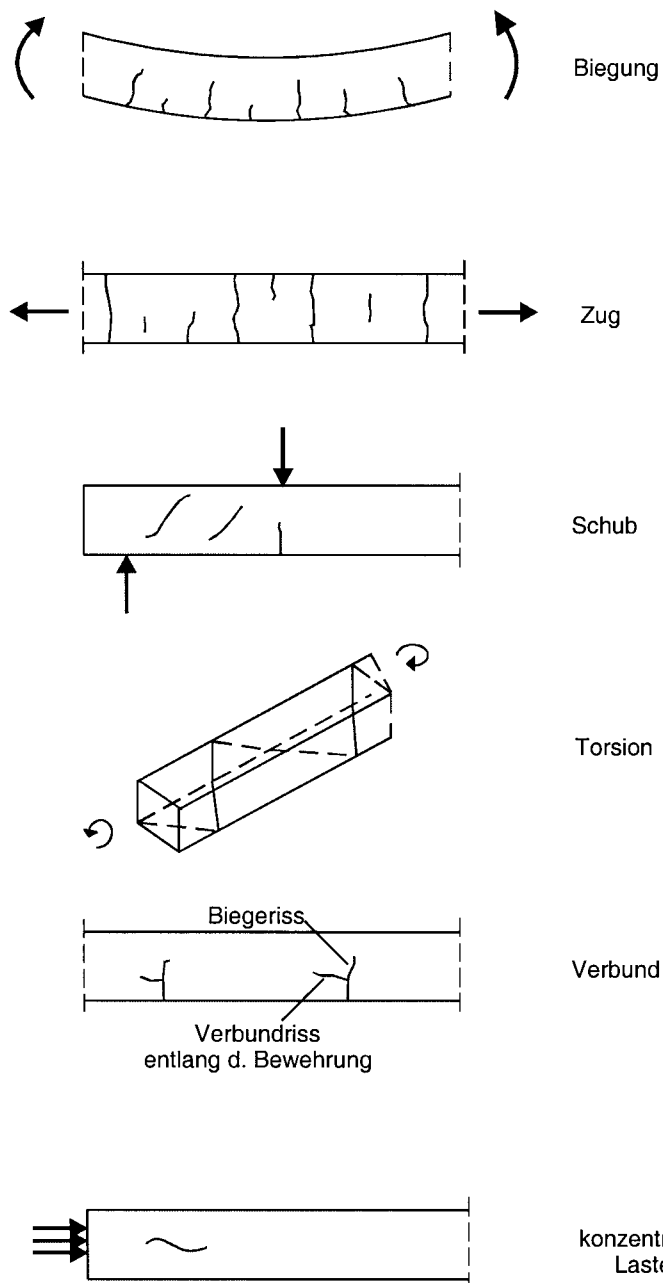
Rissbildung aus Last (+ Zwang) – Rissursache und typische Rissbilder
